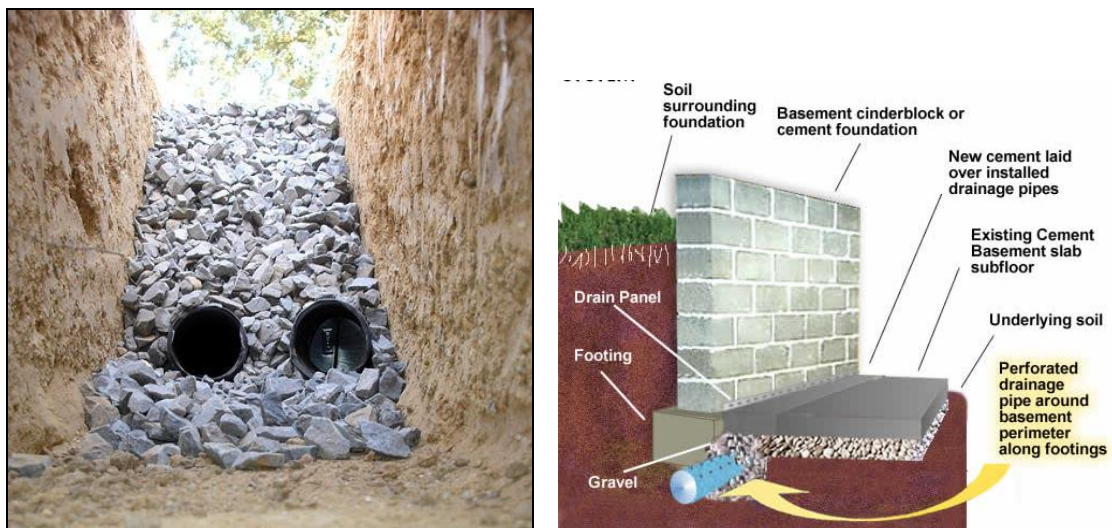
Esempio di tubazione drenante [<http://www.askthebuilder.com>]
